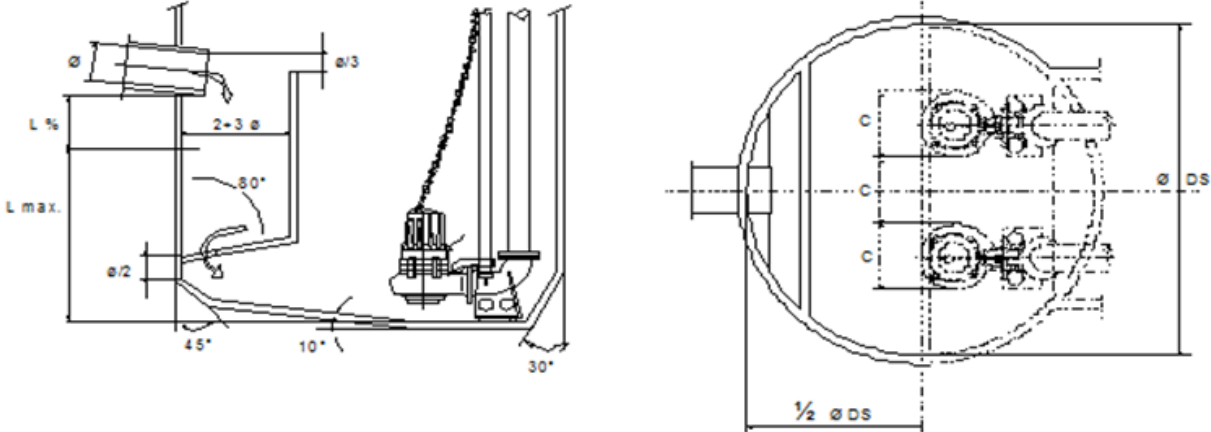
Dimensions de la deuxième bache d'aspiration
